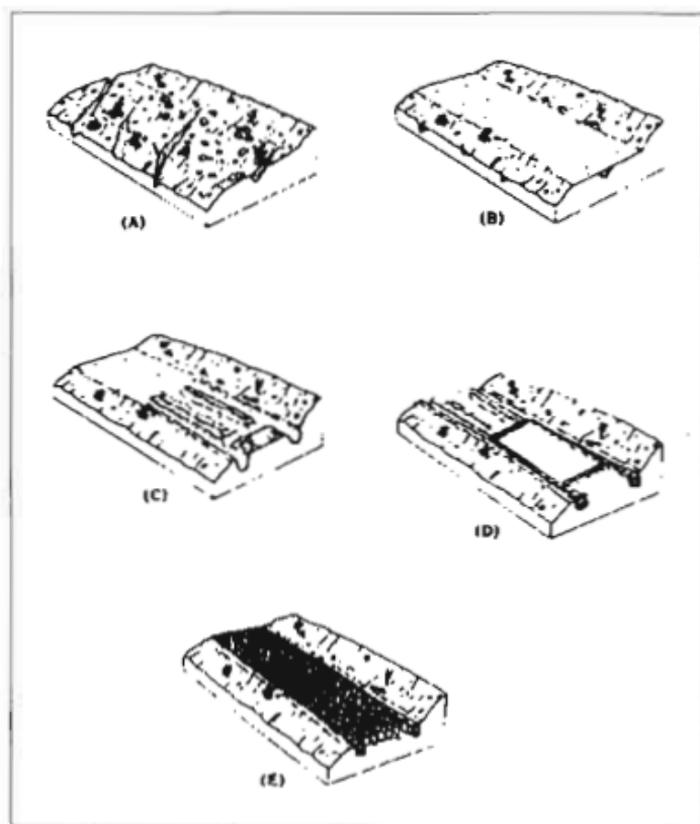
El empedrado se realizaba tras acondicionar el terreno (A y B), y excavando un hoyo para cada piedra; primero en el perímetro de la zona a empedrar y en las muestras transversales (C), y posteriormente en el espacio interior (D y E). (Dibujos de J. F. Almeida Morales, tomado de Santana Santana, A. y Moreno Medina, C., 1994).
